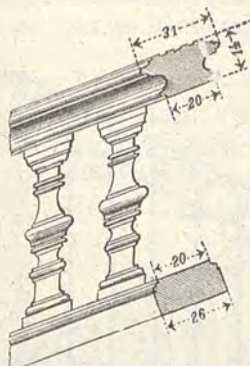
Parapetto dello scalone del Palazzo Madama a Torino.
